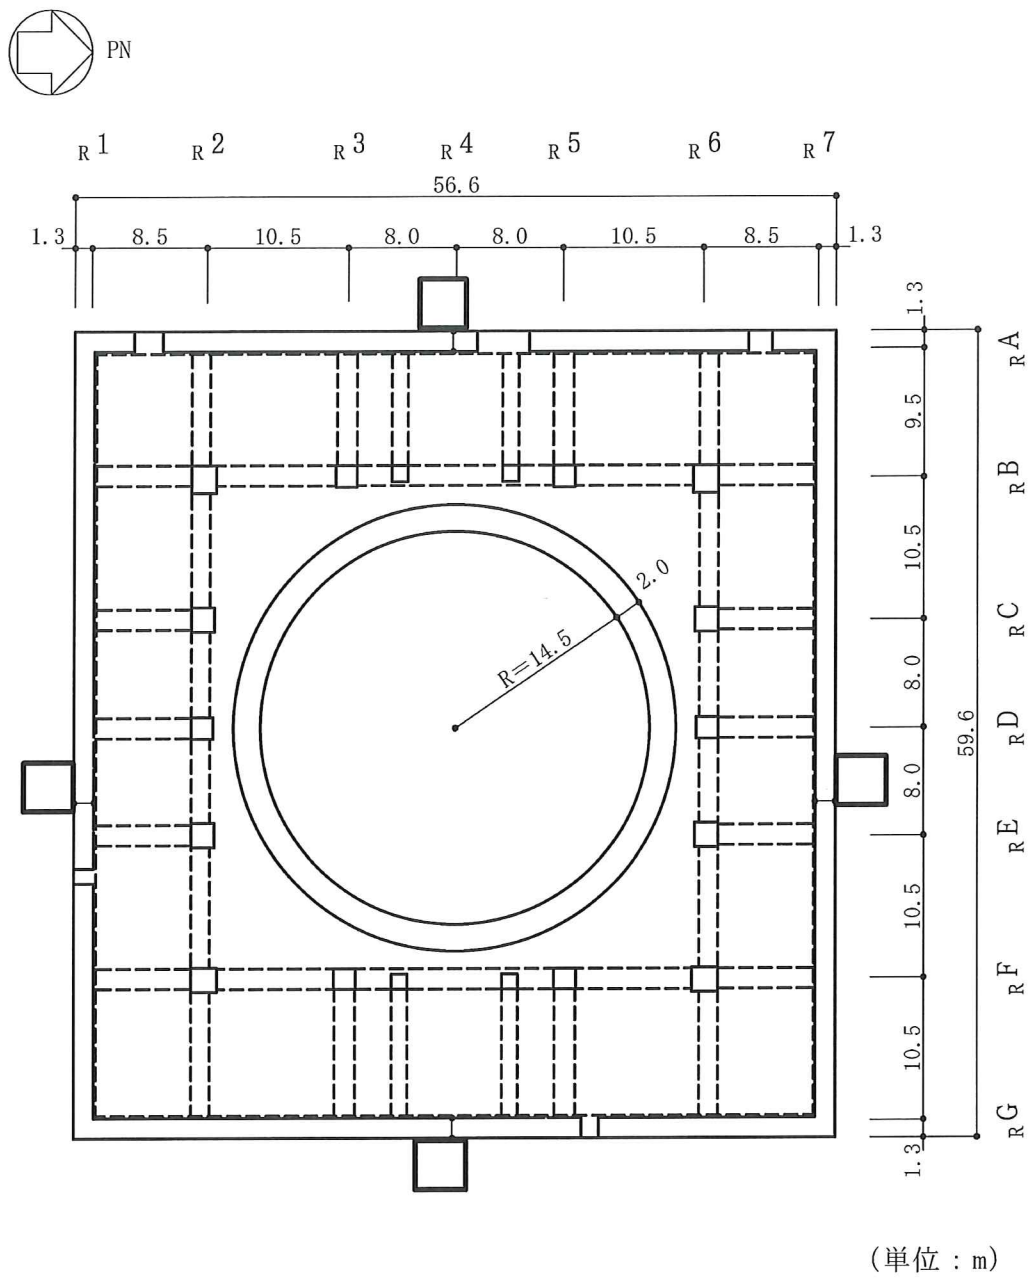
6号機原子炉建屋の概略平面図 (B1F, T.M.S.L. 4.8m) (3/9)
